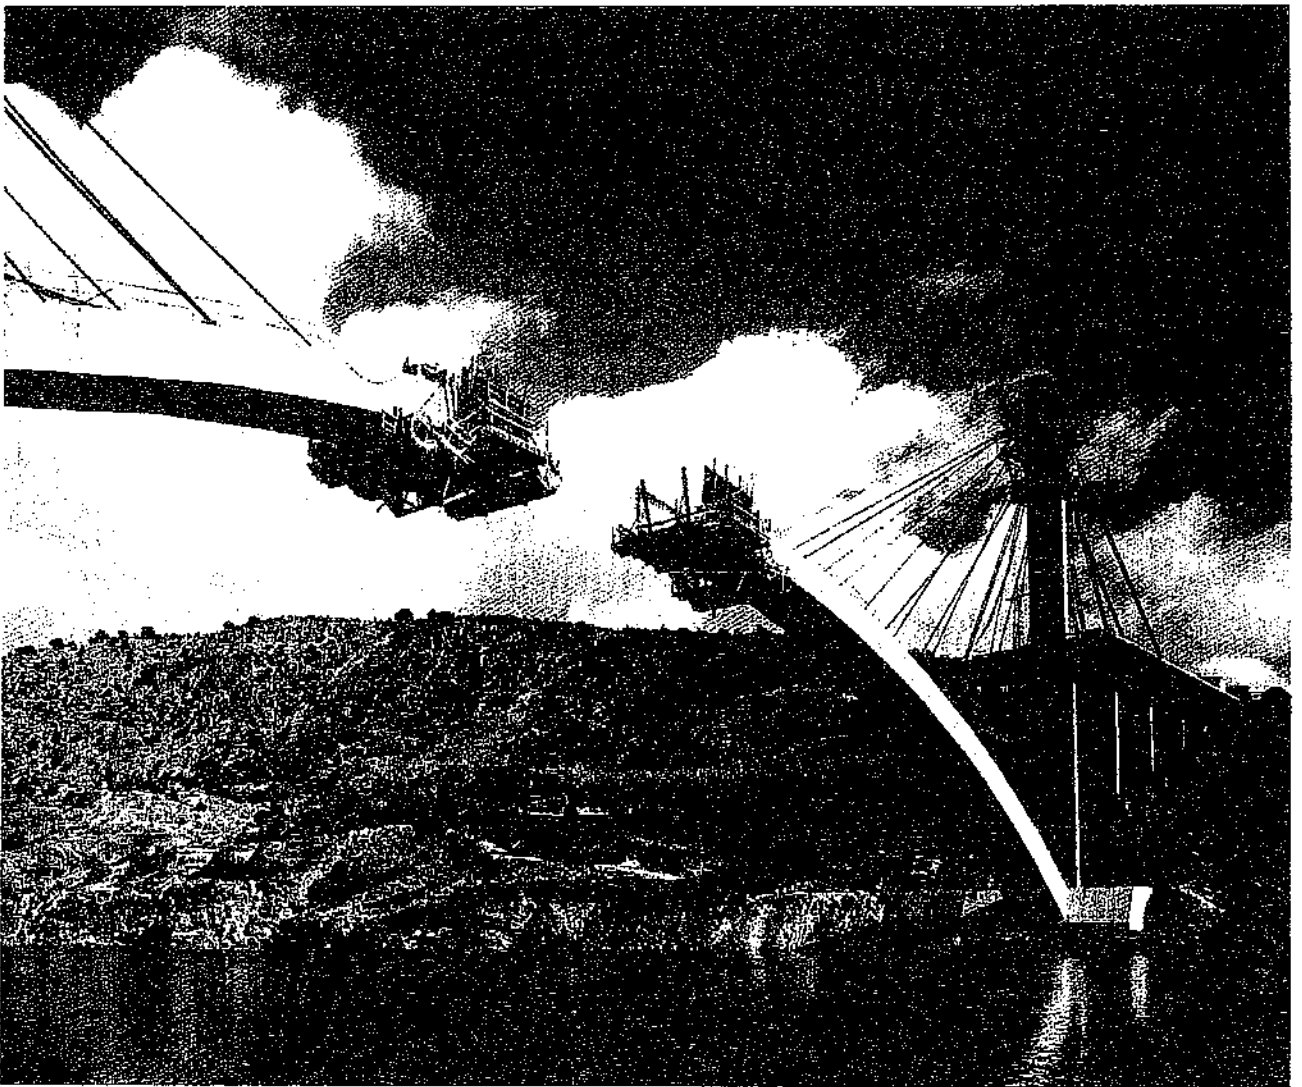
Vista del arco en una fase del procedimiento constructivo.
